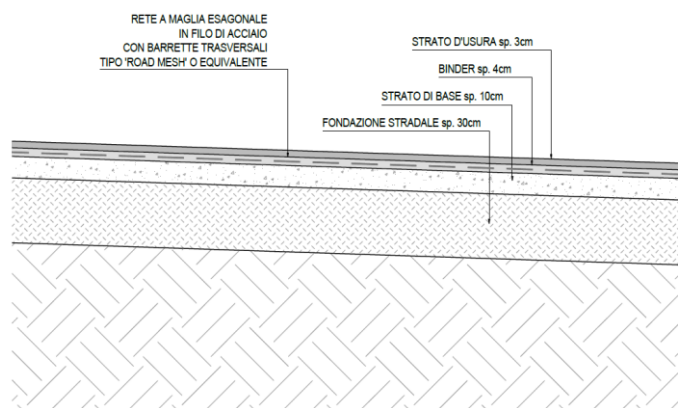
Stato di progetto - Dettaglio stratigrafia nuovo impalcato
